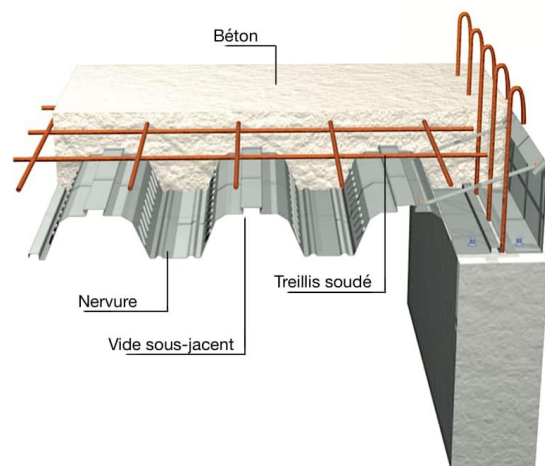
image montrant le plancher collaborant en assemblant au poteau béton, source : www.futura-science.com
